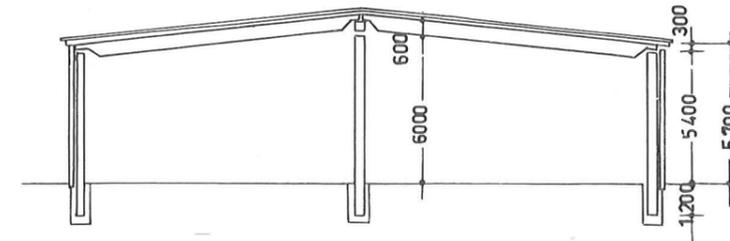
Stützen-Riegel-Konstruktion - Mustergebäude mit Fassadenbeispielen
